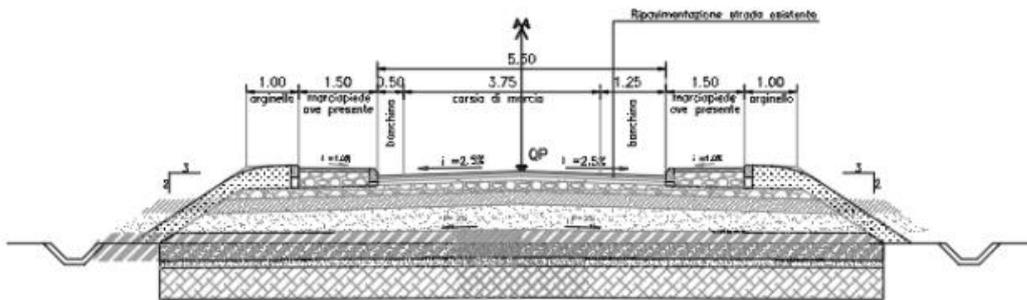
sezione tipo per asse oggetto di sola ripavimentazione, a senso unico, con corsia da 3,75 m e banchine laterali
